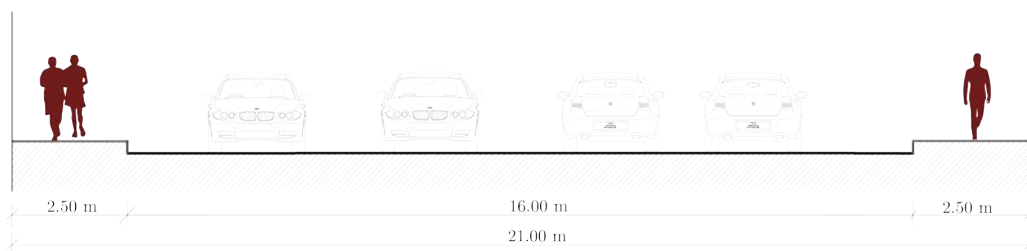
Sección de la Avenida East Pershing Road. Elaboración: Propia.
